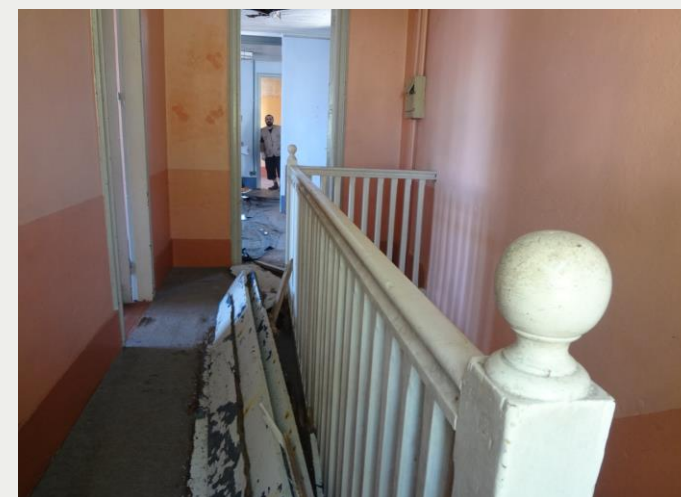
Circulação e guarda-corpo em madeira, pavimento superior. Fonte: Equipe SNA, 2018.
